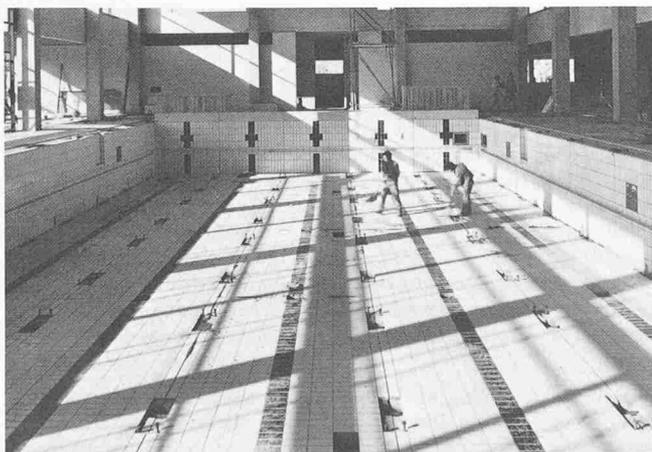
Montage der Wandelemente des Schwimmbeckens Hallenbad Adliswil
